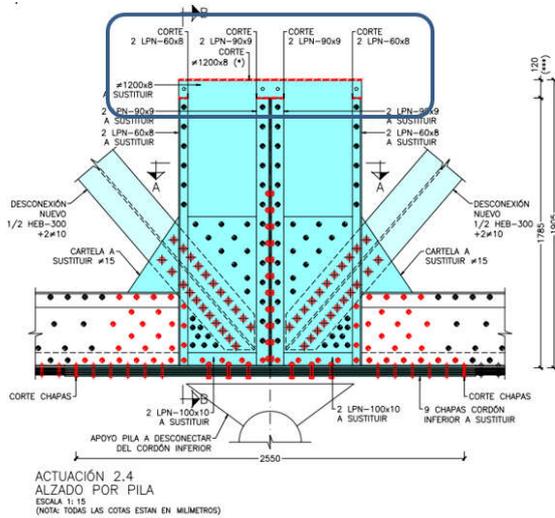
Nudo inferior mamparo de pila. Corte de angulares
